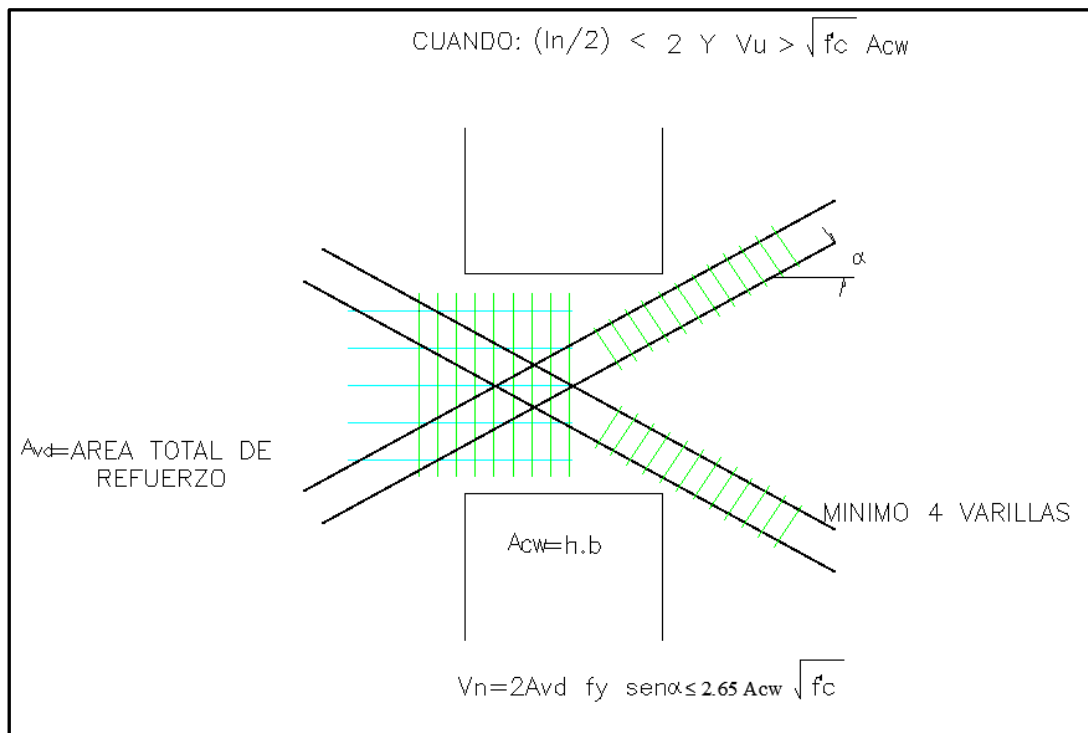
VIGA DE ACOPLA DE LA ALTERNATIVA 1
